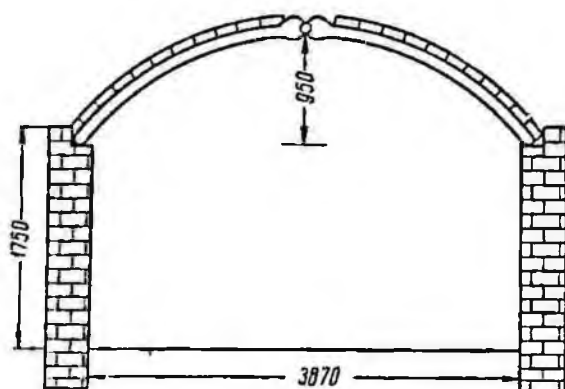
Смешанная крепь со сборным железобетонным арочным перекрытием
